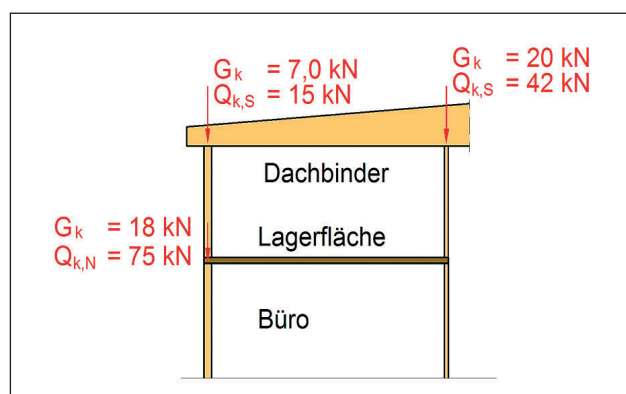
System und Belastung einer Außenstütze einer Lagerhalle
